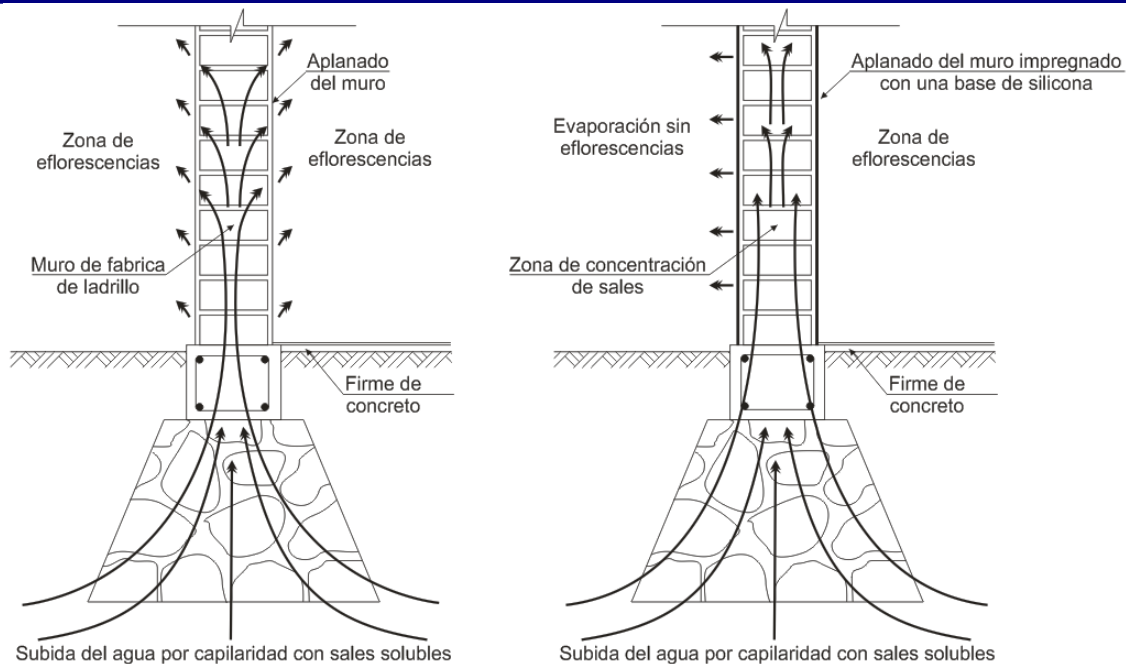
Comportamiento de las humedades ascendentes, cargadas de sales solubles, ante un muro desprotegido (a la izquierda), con aparición de eflorescencias y un muro impermeabilizado a base de siliconas (derecha) que impide la formación de las mismas.
